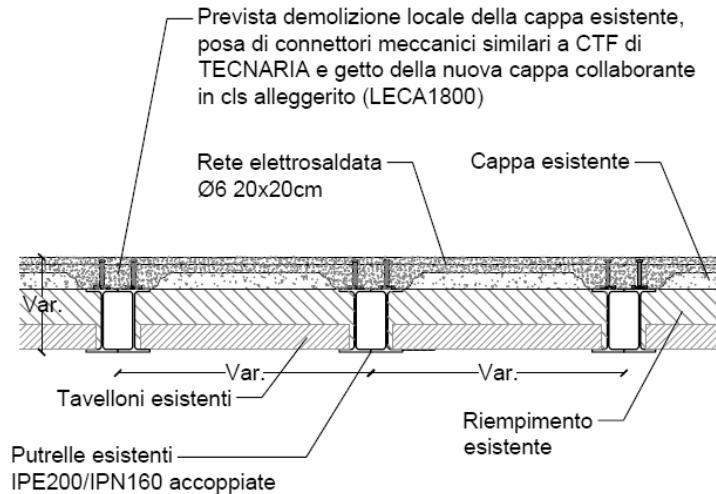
schema di piolatura del solaio in putrelle e tavelloni (disegno tecnico da progetto per la riqualificazione residenziale dell'Ex Ospedale S. Margherita a Pavia, lavori di Studio Calvi BEAM BEAM).
